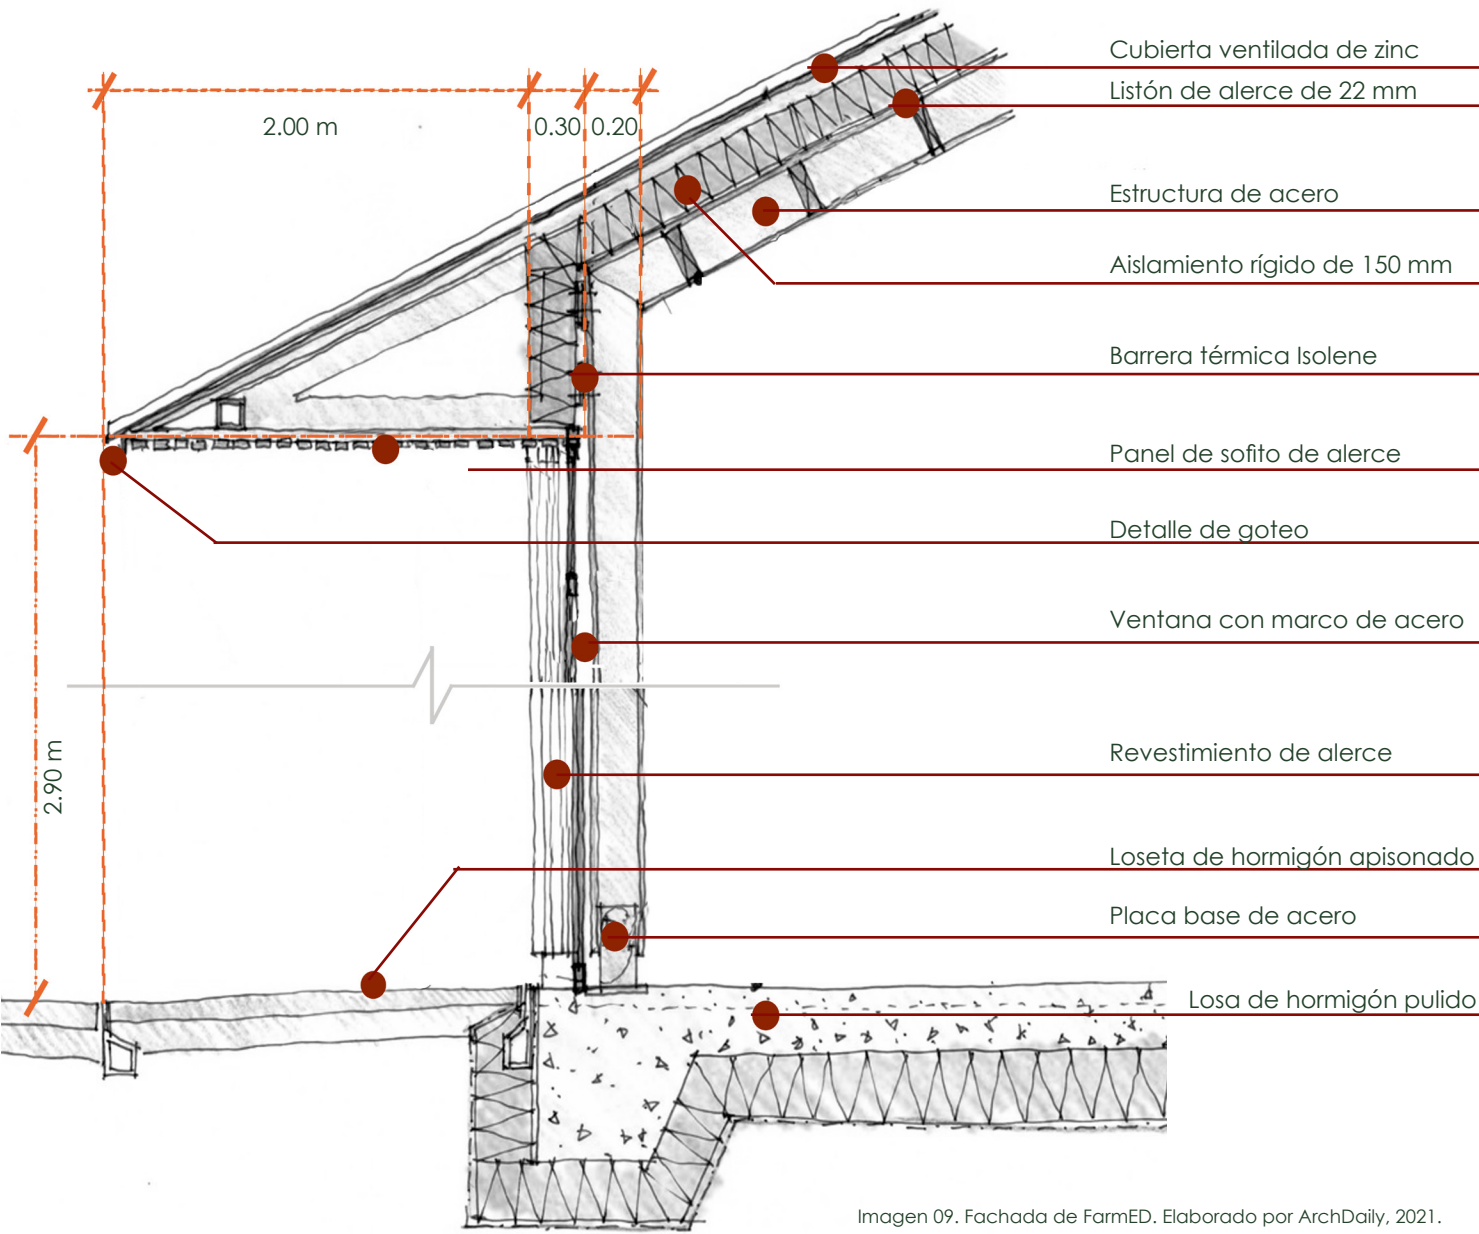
Fachada de FarmED. Elaborado por ArchDaily, 2021.
